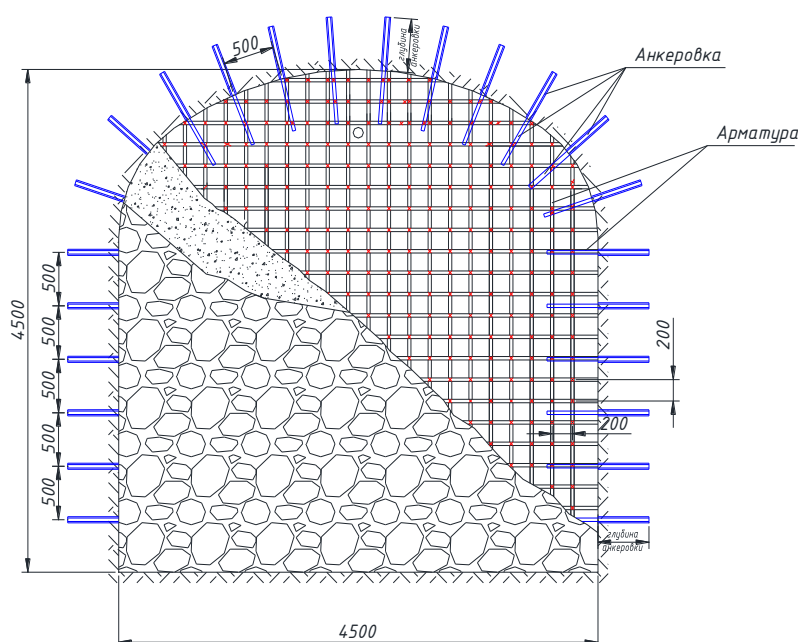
Конструкция железобетонной перемычки и ее конструктивные элементы при заделке по стенкам и кровле выработки с шагом 0,5 м
